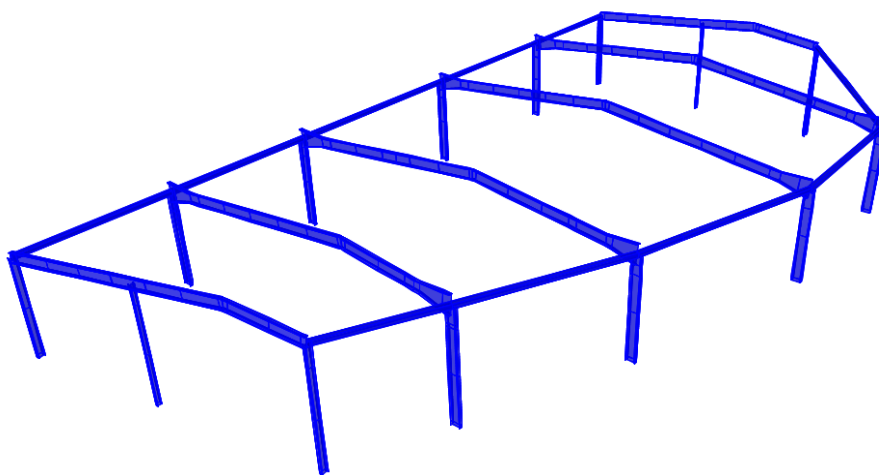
Perspectiva geral dos pórticos que constituem o pavilhão.
